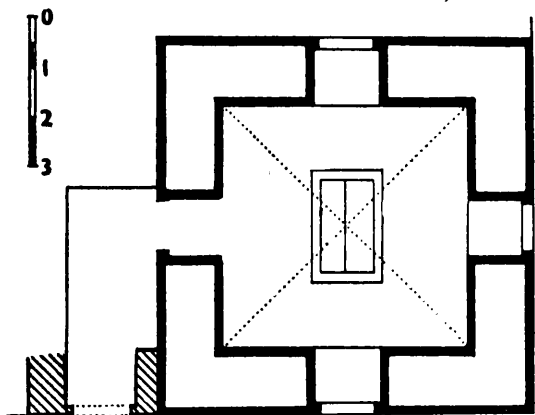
TOMBEAU DE MITQÂL : plan.
